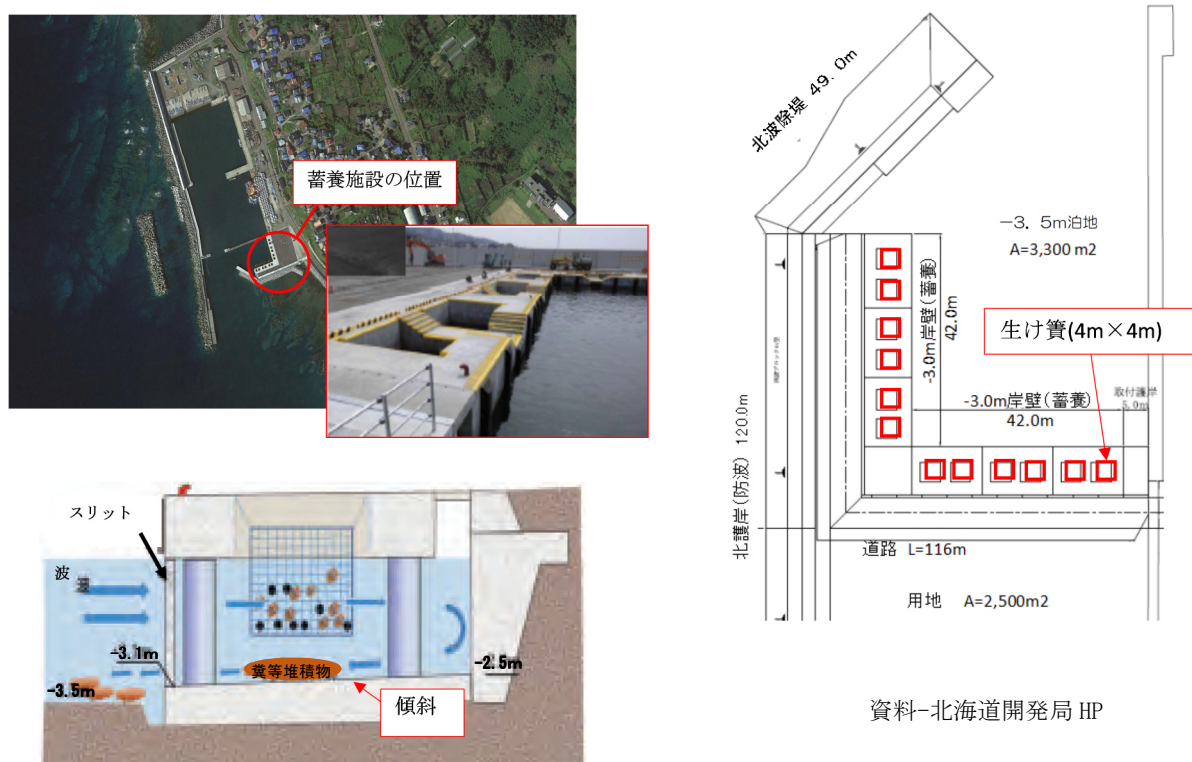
蓄養施設の位置、平面配置、断面構造
